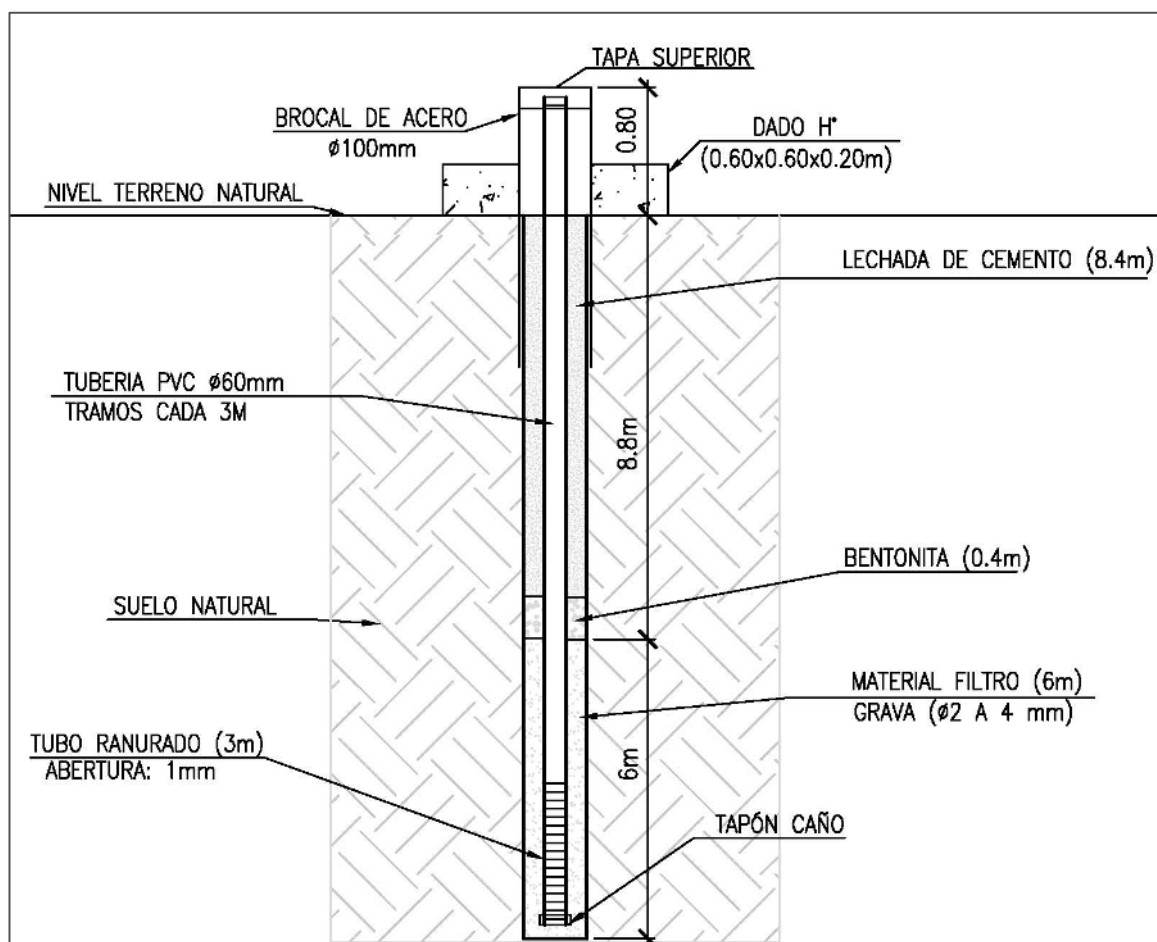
Esquema del piezómetro instalado en cada perforación
